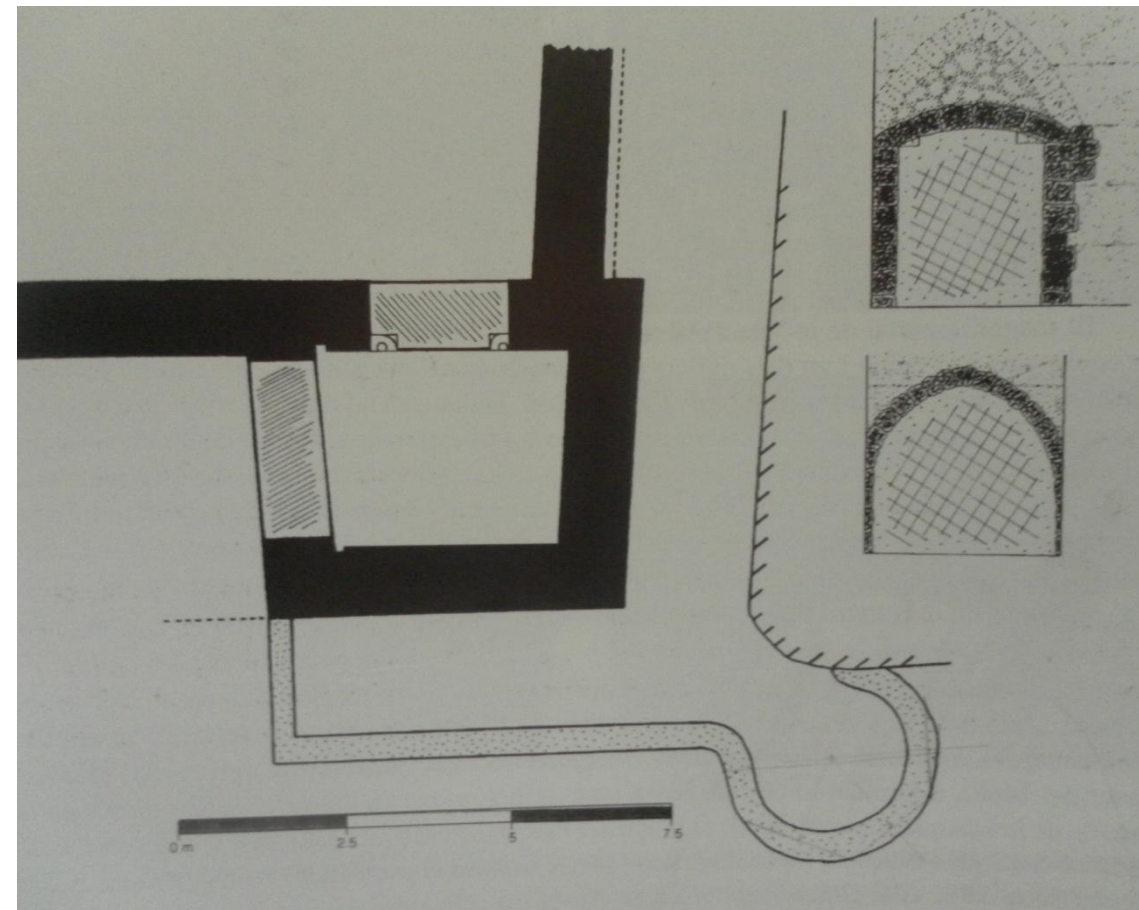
Figura VIII. Plano de la planta y alzado del portal d'Ontinyent.
